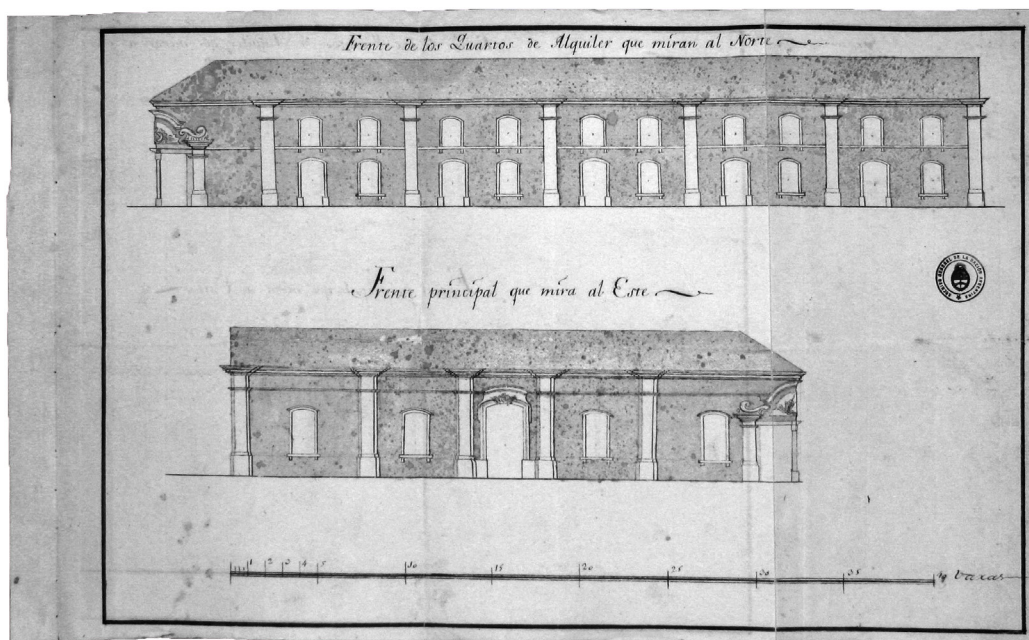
Plano de las fachadas de la casa de don Juan José Castro, barrio de la Merced.<sup>50</sup>
